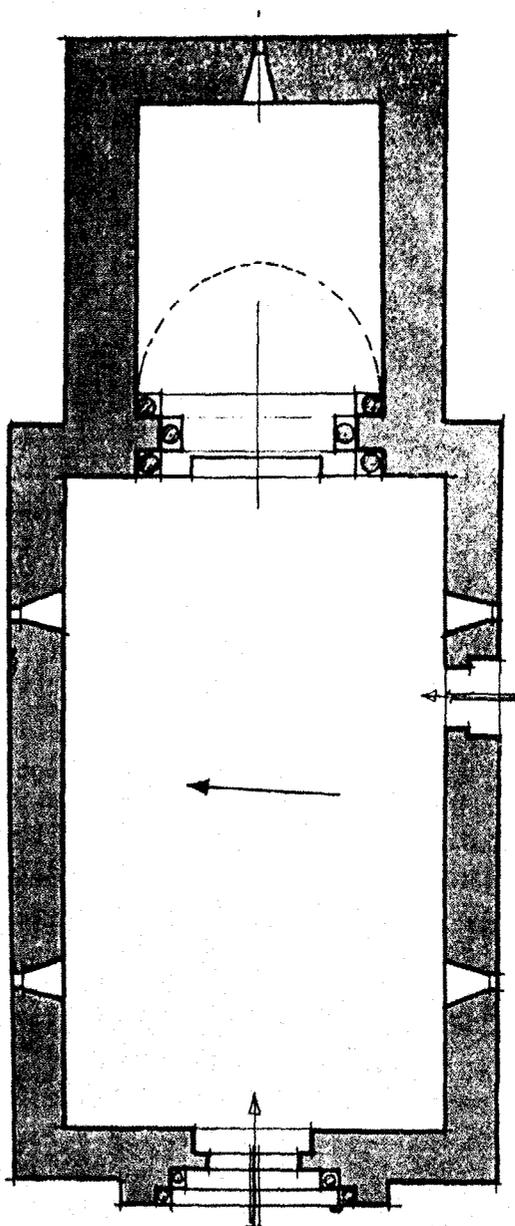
Santa Eulalia de la Lloraza. Planta-Esc. 1:100
